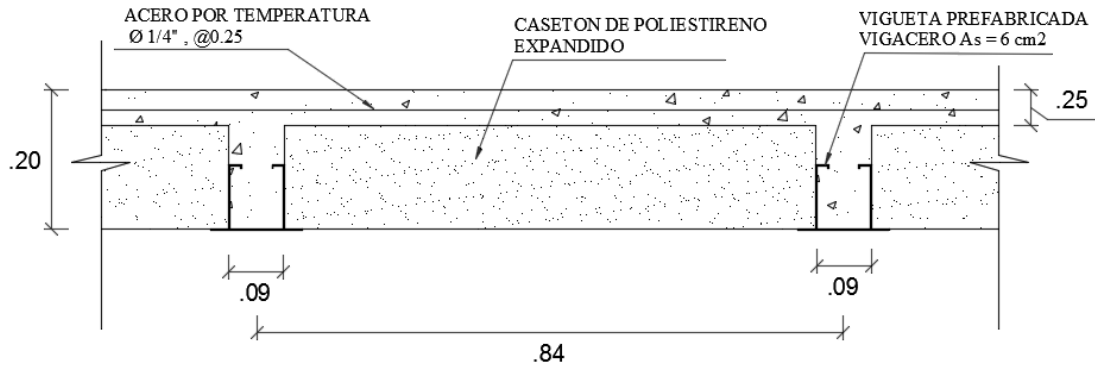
Corte transversal en losa aligerada con VIGACERO. Elaboración propia.
